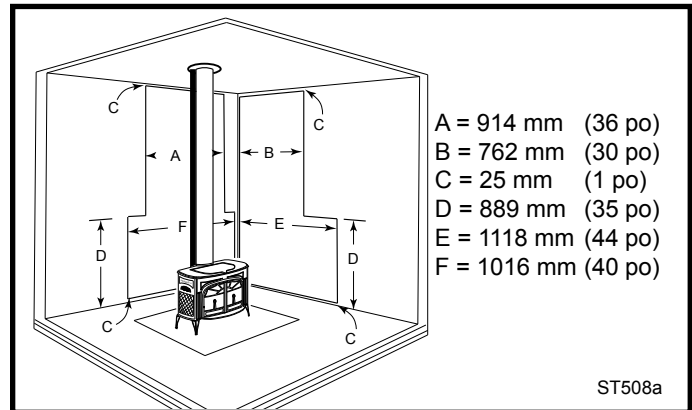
Installation parallèle, connecteur vertical de cheminée avec poêle, connecteur et protecteurs muraux. Réduction maximale pour murs arrière et latéraux. Les protecteurs muraux peuvent se rejoindre dans un angle. Un écran thermique ayant un diamètre de 610mm (24po) suspendu à 25mm (1po) sous le plafond doit entourer la cheminée.
